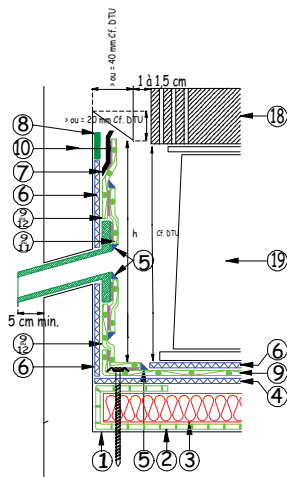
Relevé avec protection lourde par dalles sur plots Trop plein
